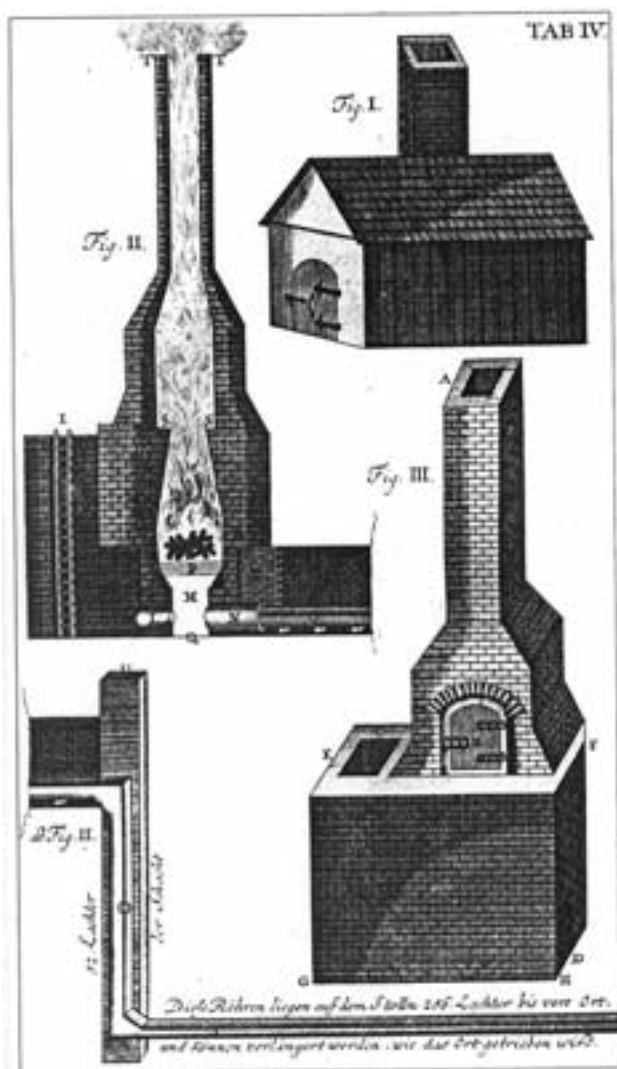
Aus Calvörs "Maschinenwesen": Dampfmaschine (Feuermaschine) zur Bewetterung von Gruben
